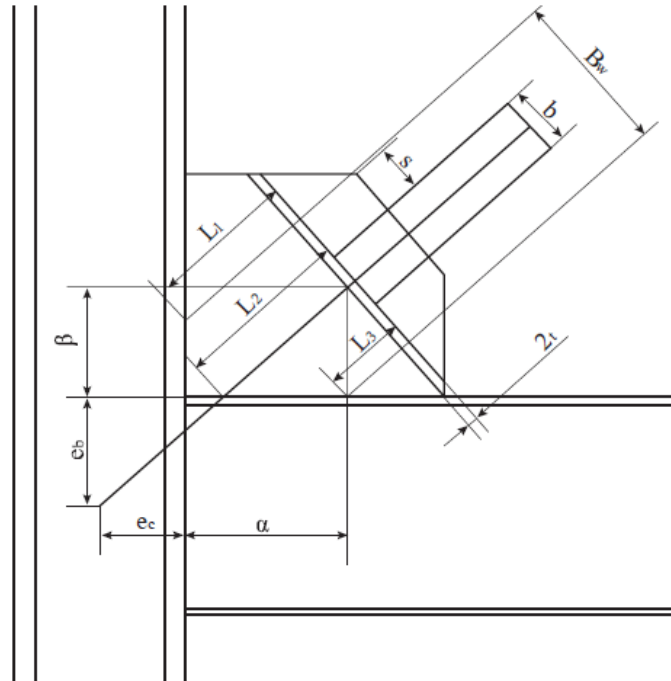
Detalle de conexión viga-columna con arriostramiento (conexión a momento).
